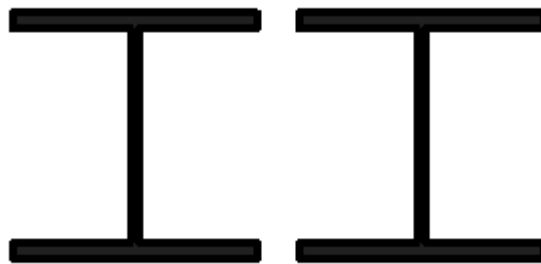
Vista de planta de los pilares HEB dispuestos en la junta de dilatación. Fuente: elaboración propia
